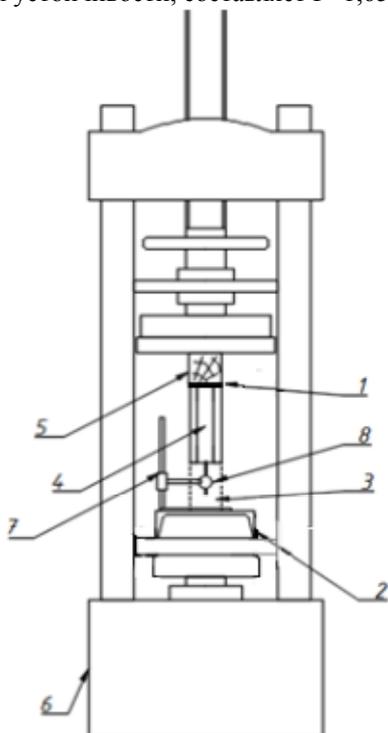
Схема установки образца на испытательный стенд: 1 – стальные пластины в местах передачи нагрузки; 2 – швеллер; 3 – опора под образцом; 4 – опытный образец – балка; 5 – траверса из бруса (100×100 мм); 6 – гидравлический пресс П-50; 7 – штатив; 8 – индикатор часового типа
